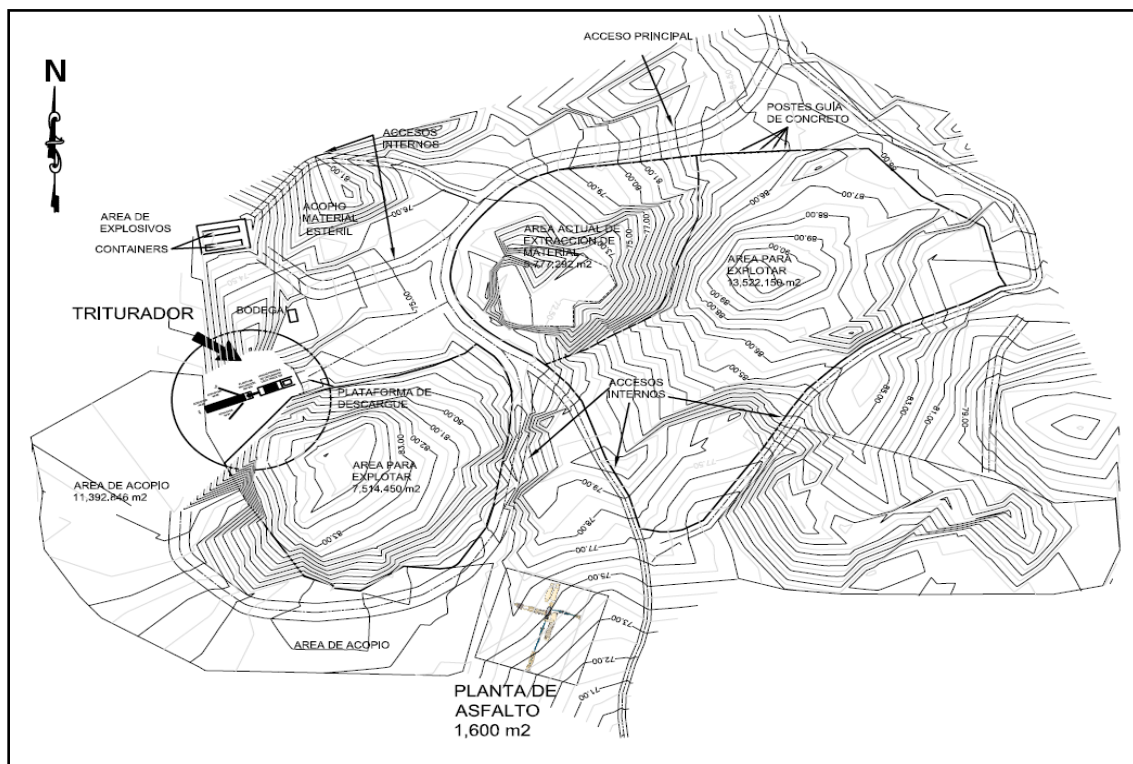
Distribución de las áreas, planta trituradora y planta asfáltica.
